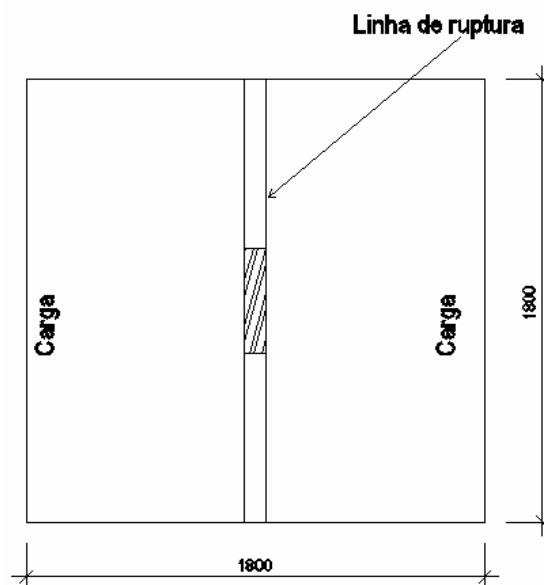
Linha de ruptura em lajes com pilar retangular com carga nos dois bordos
